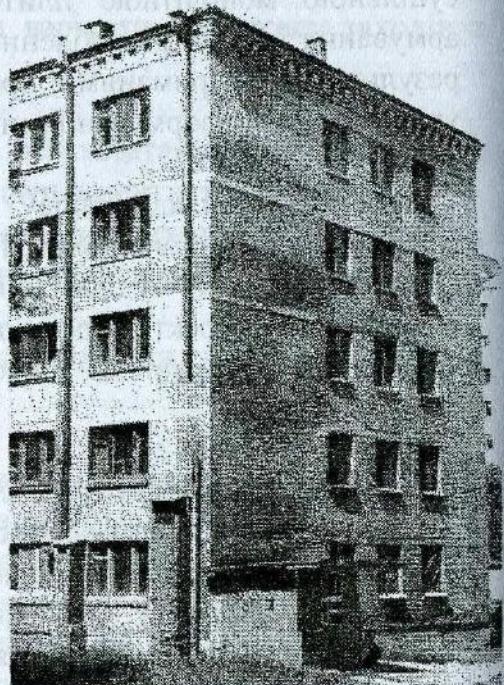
Вид на бічний фасад будівлі по вул. О.Теліги
